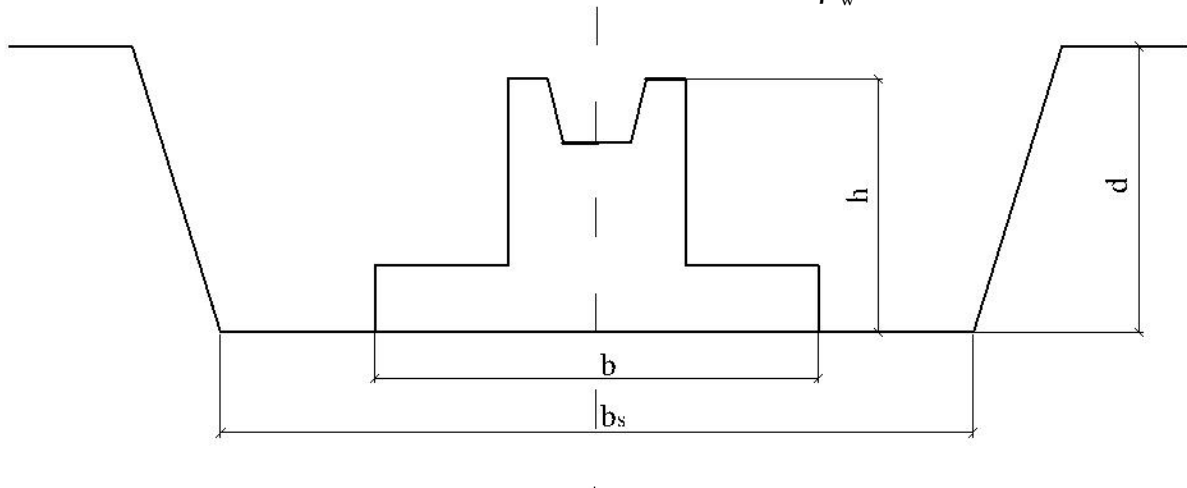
Фундамент на попередньо ущільненому ґрунті
